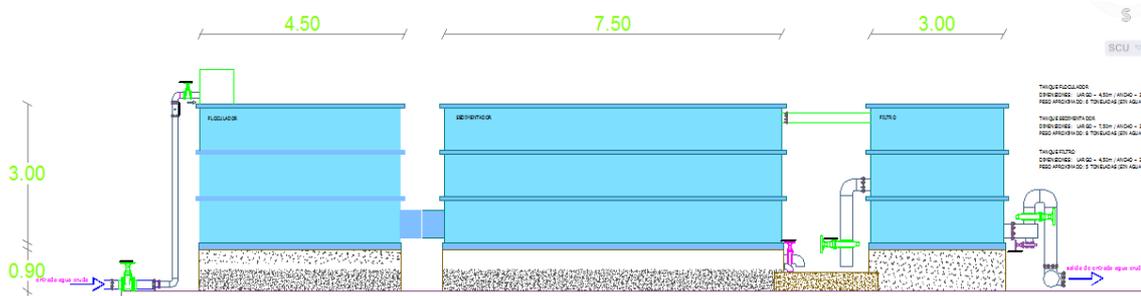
Vista en corte, planta de tratamiento modular 2D
